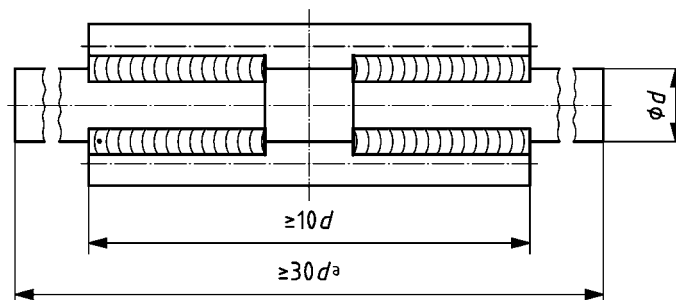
Probe für Zug- und Biegeversuch an einem Stumpfstoß
